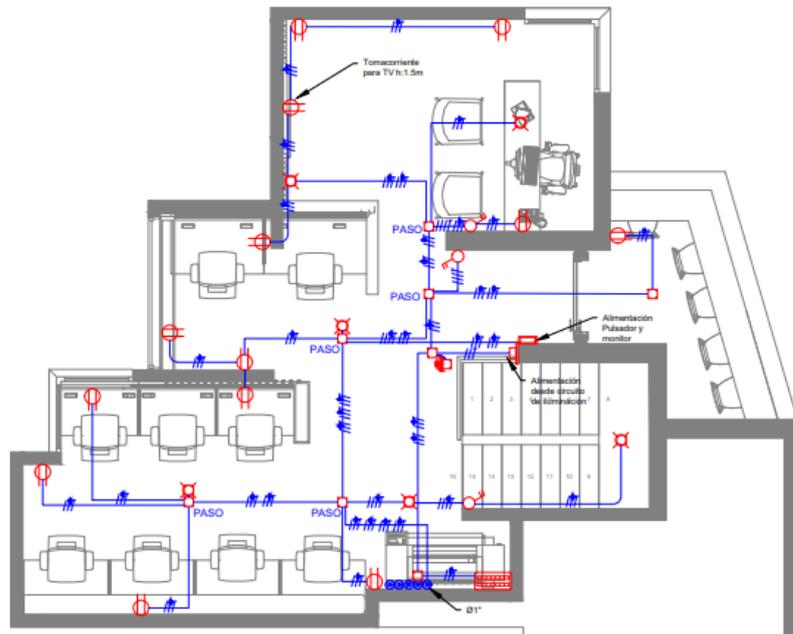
Plano salidas e iluminación, Sede de oficinas [1].
